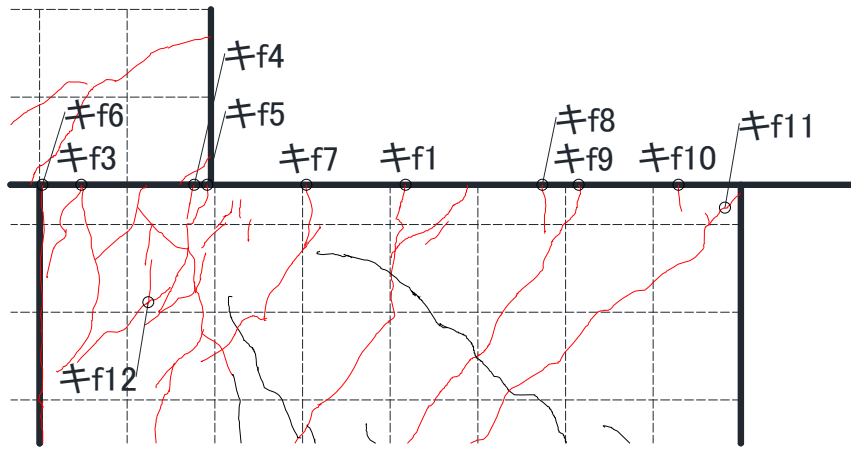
基礎梁ひび割れ幅測定位置(試験体 DR-2 -7.0 サイクル 観測面)
